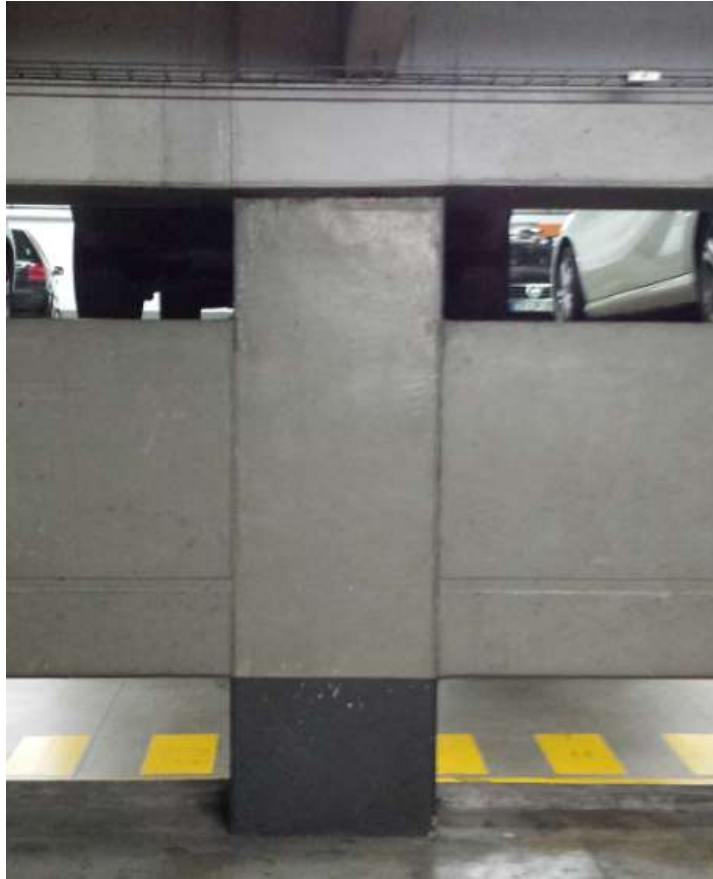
Vigas “T” pré-fabricadas (Acervo pessoal, 2015)
